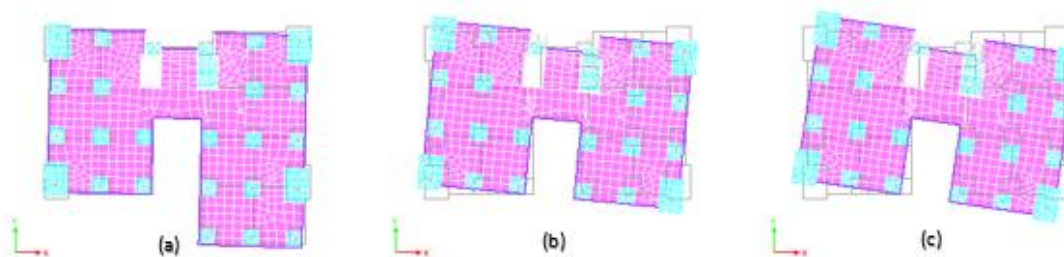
Vista en planta del modo de vibración 2 correspondiente al Caso 1. a) Segunda Planta. b) Quinta Planta. c) Octava Planta.
